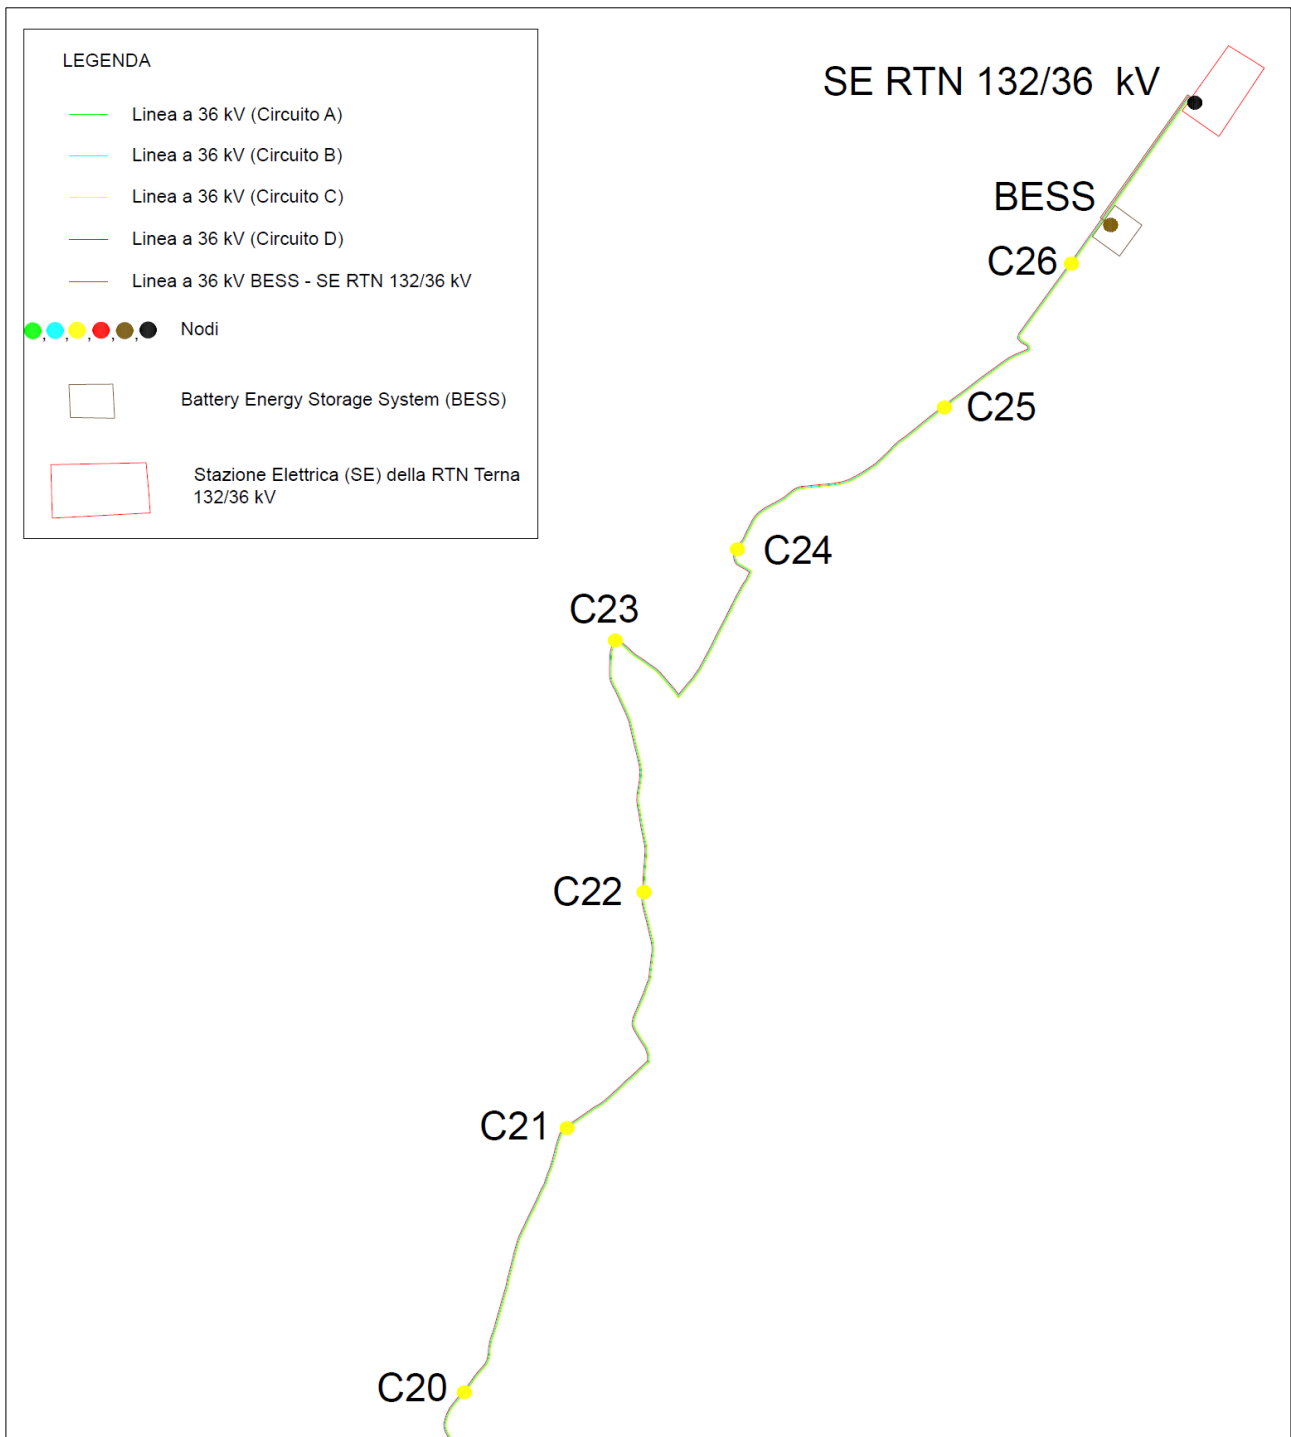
Dettaglio 3 della planimetria di distribuzione linee a 36 kV
